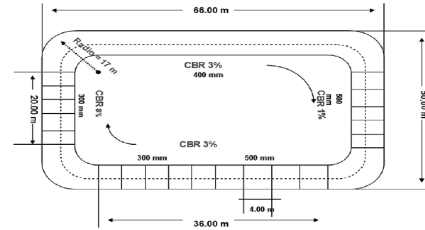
Vista en planta de la sección típica de la vía utilizada en el ensayo
